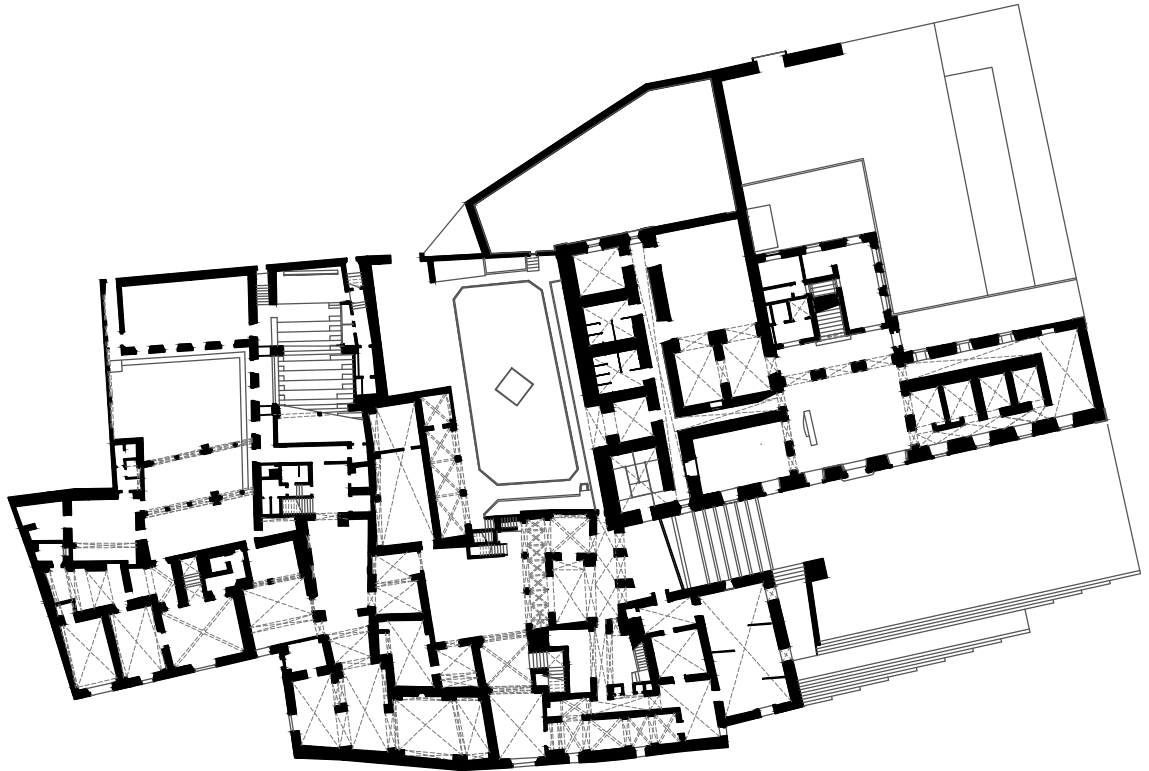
EVOLUÇÃO EM PLANTA PISO 0 E ALÇADO, Séc.XXI, Escala 1:700
